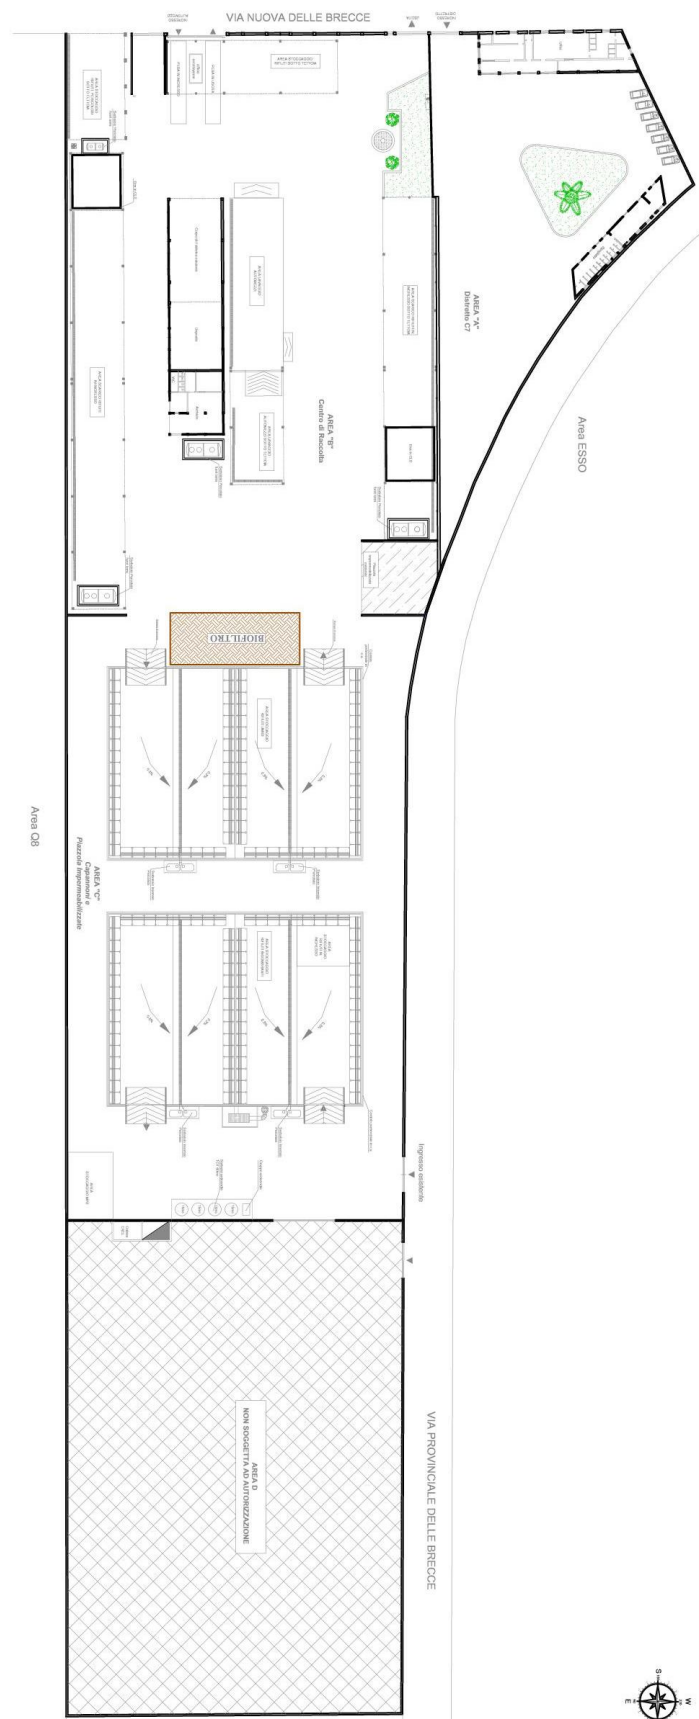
Planimetria Pavimentazioni dello stabilimento della ASIA di Napoli – loc. Ponticelli (NA)
